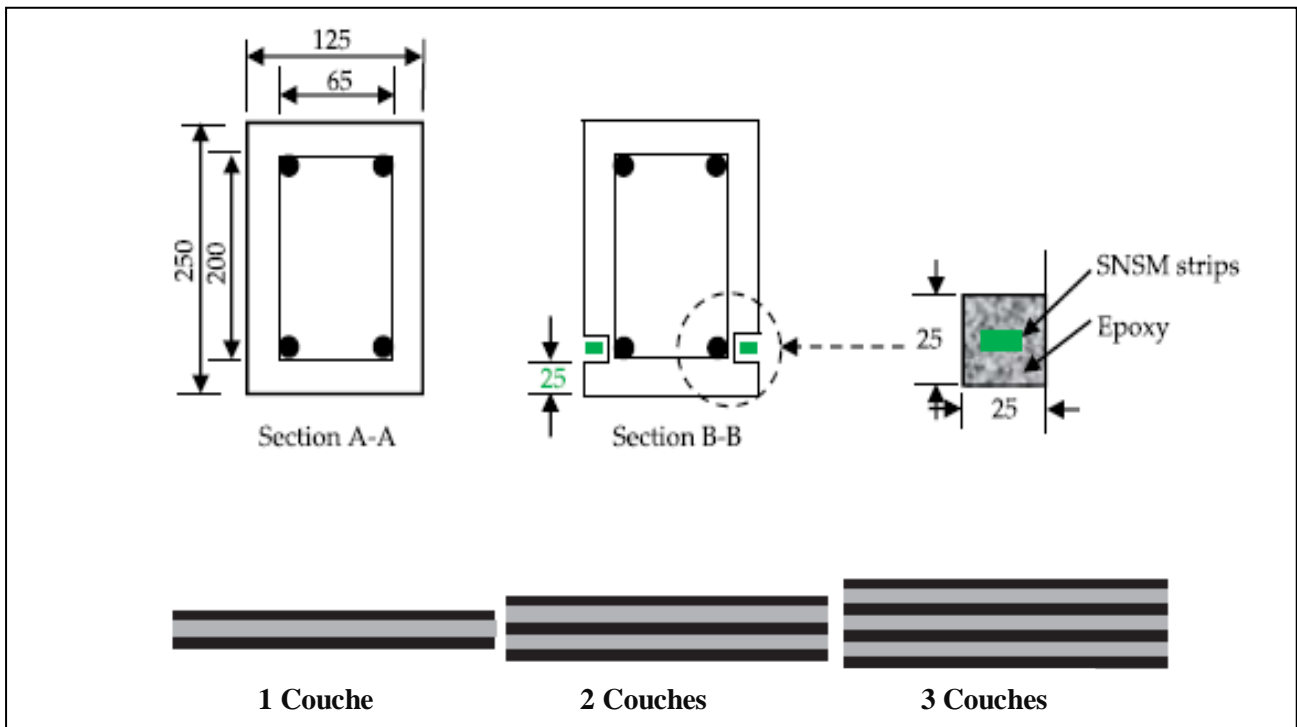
Configuration des poutres testées par (Hosen et al., 2018).
